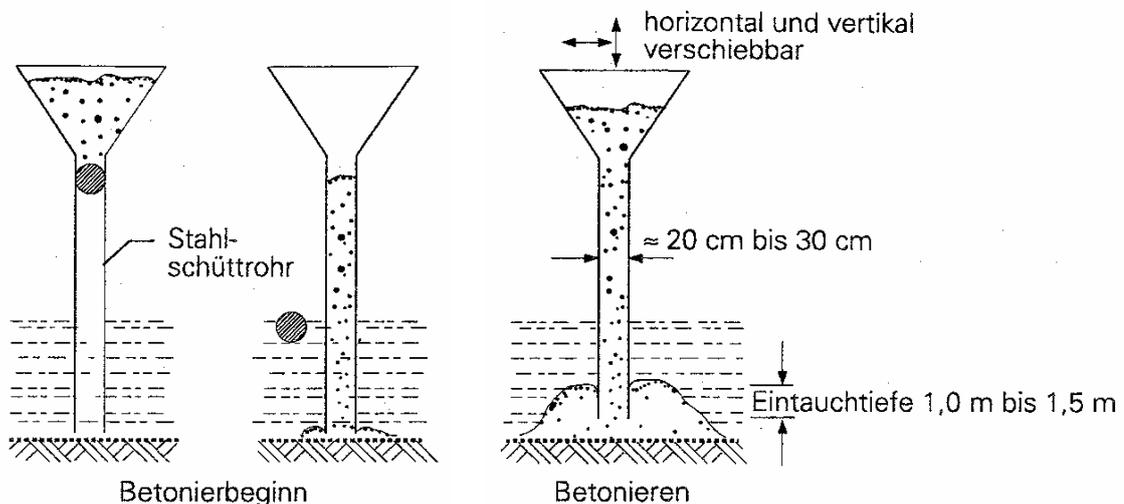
Einbauverfahren für Unterwasserbeton - Contractor-Verfahren [19]
